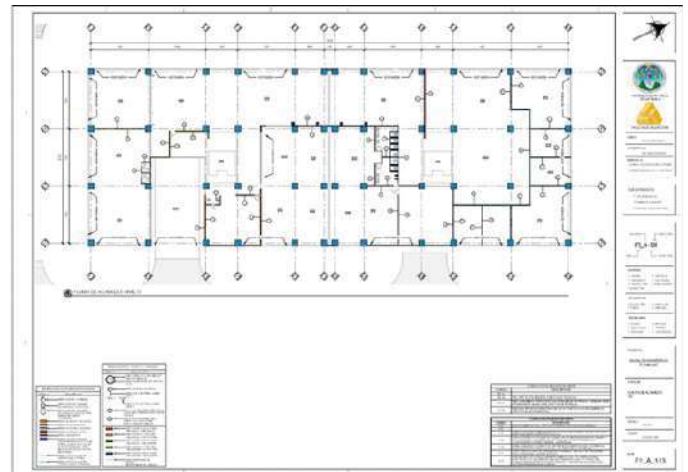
Ejemplo de plano de acabados en muros trabajado para un proyecto de Edificio de Apartamentos solicitado para Diseño Arquitectónico 7. Elaborado por Jonathan Rodriguez. Guatemala, Octubre de 2017.
